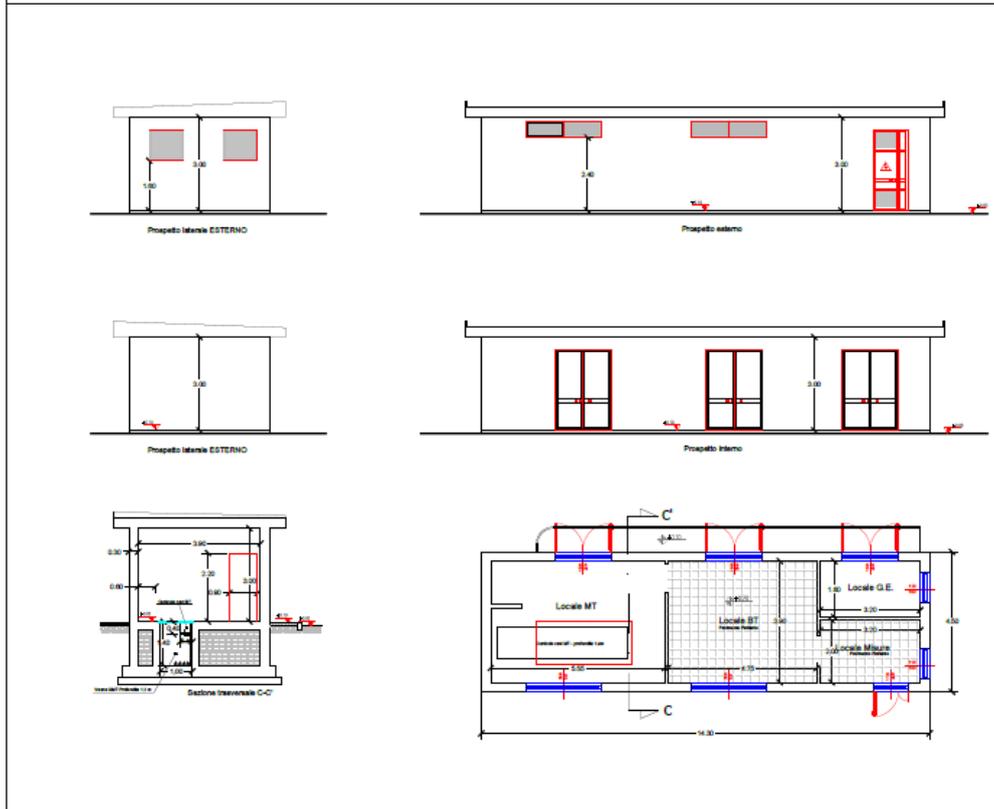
Locali tecnici stallo di elevazione AT/MT
